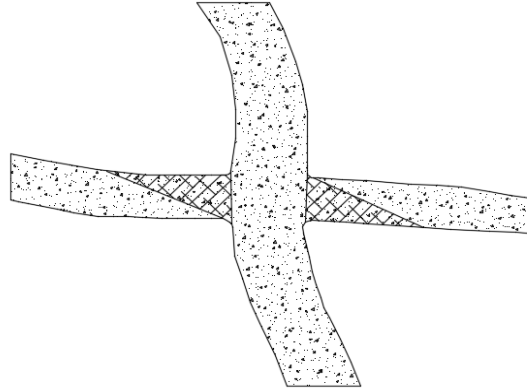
Comportamiento de la unión viga-columna interior ante la acción de un sismo.
